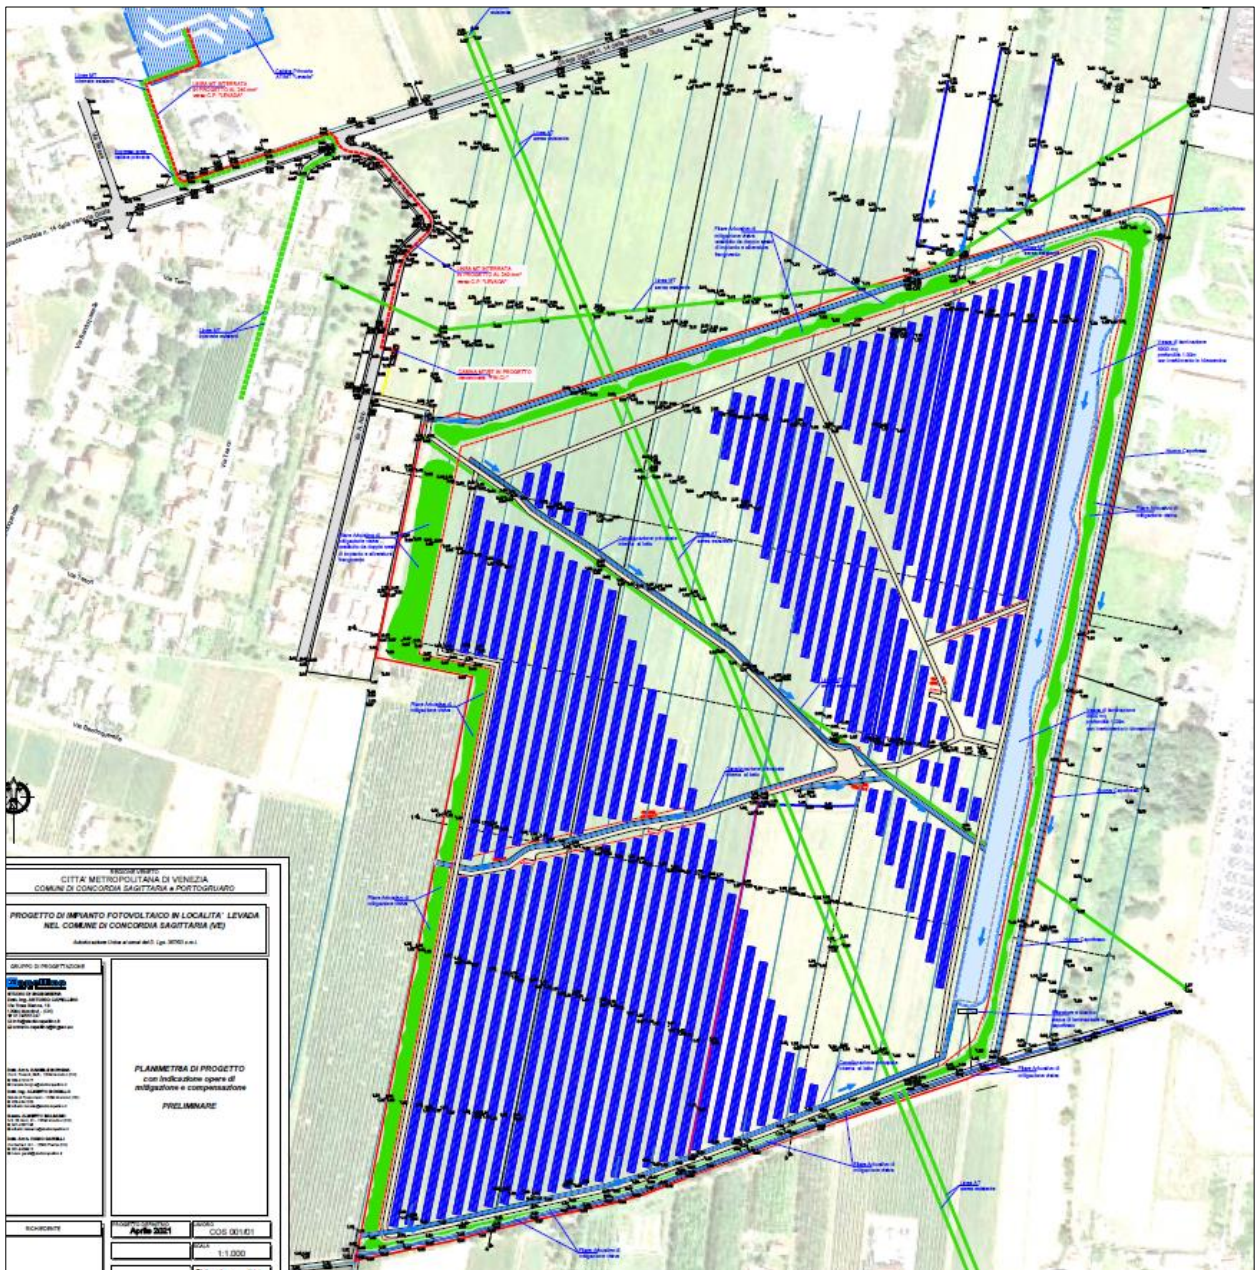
Planimetria di progetto con indicazione dei pannelli e delle principali opere
